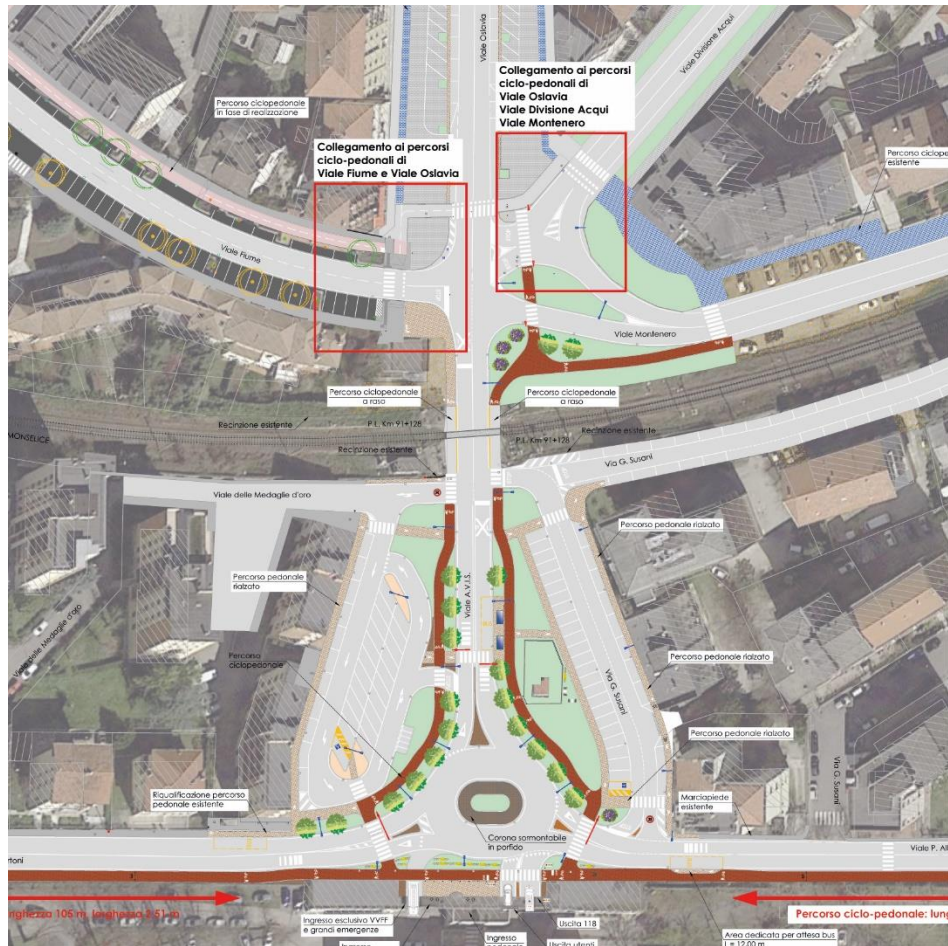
Schema di progetto dell'intersezione Viale Oslavia – Viale Fiume – Viale Divisione Acqui – Viale Montenero – Via Albertoni.
